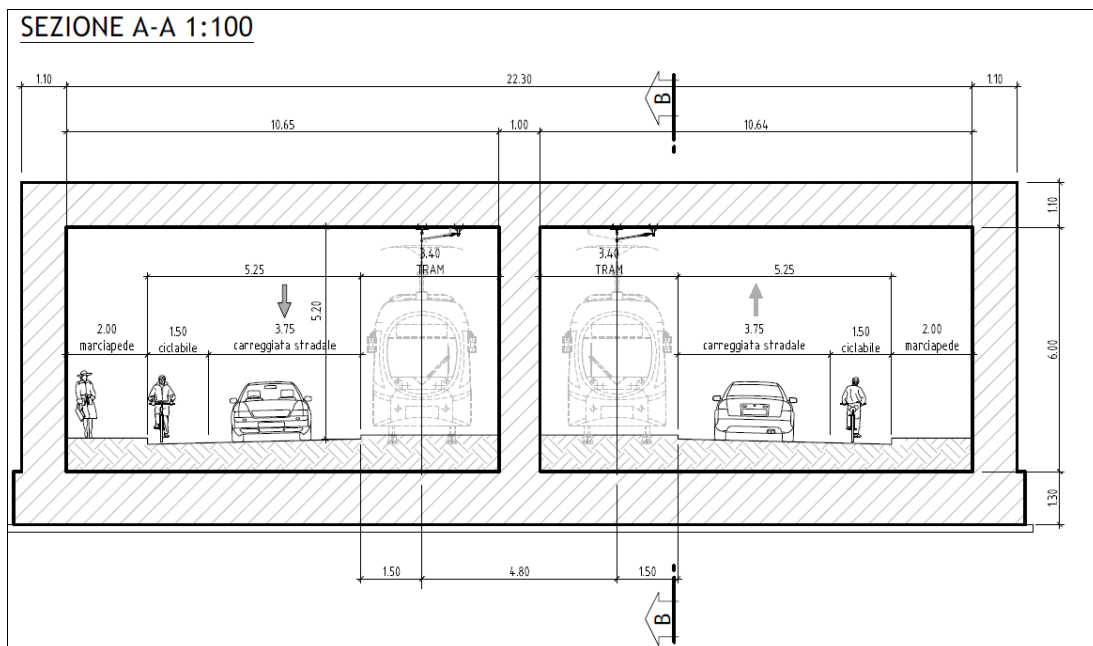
Sezione trasversale sottoattraversamento (estratto da elaborato B831-C-SF-STR-RT003A)
